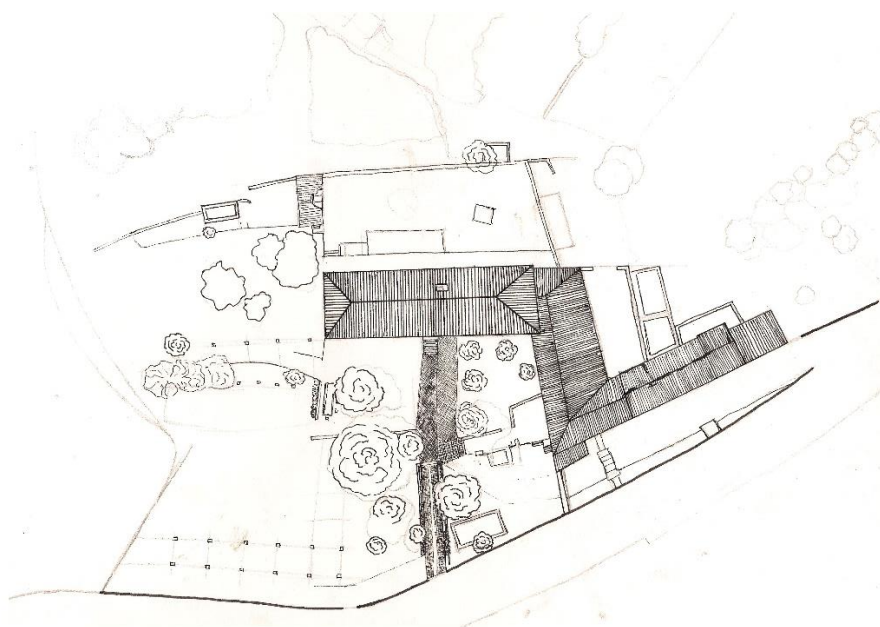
Planta de cobertura da Casa Marques (orientada a Norte)
